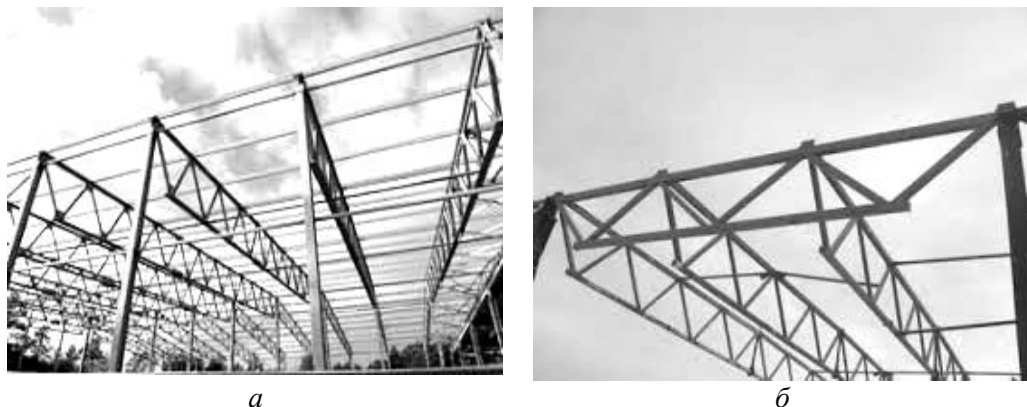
Облаштування легких конструкцій покриття: *а* – з кроком ферм, що дорівнює кроку колон; *б* – із застосуванням підкрівляних ферм
